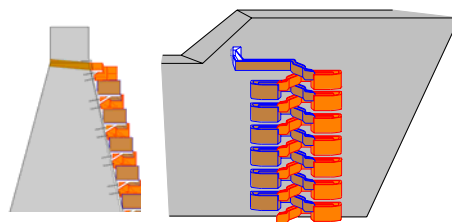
壁面魚道 側面図と正面図 Side view and front figure of "Height style wall fish way"
